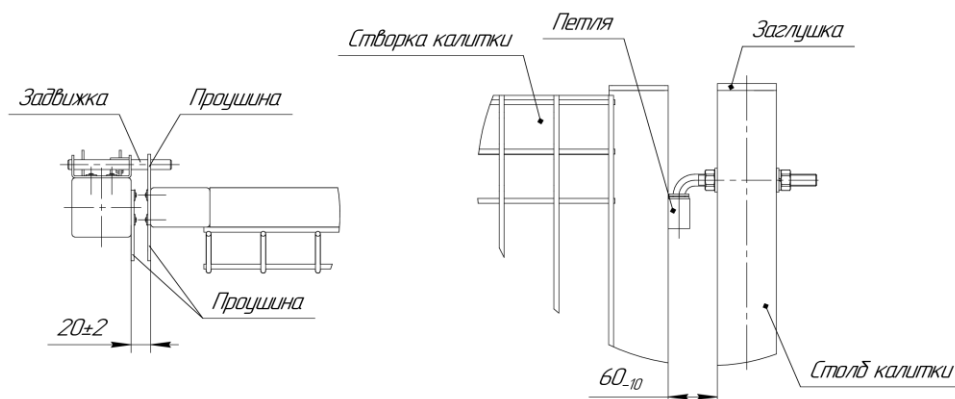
Регулировка положения створки калитки серии Fit 3D.
